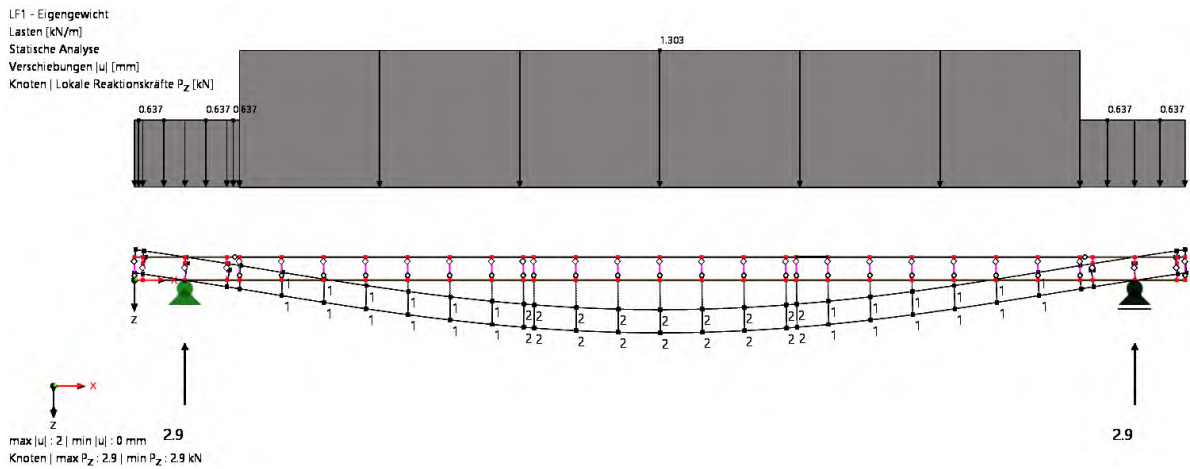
Holz-Beton-Verbunddecke unter Lastfall 1 (Eigengewicht) ständige Last (Res.=5,8kN oder 580kg, Durchbiegung 2mm).
